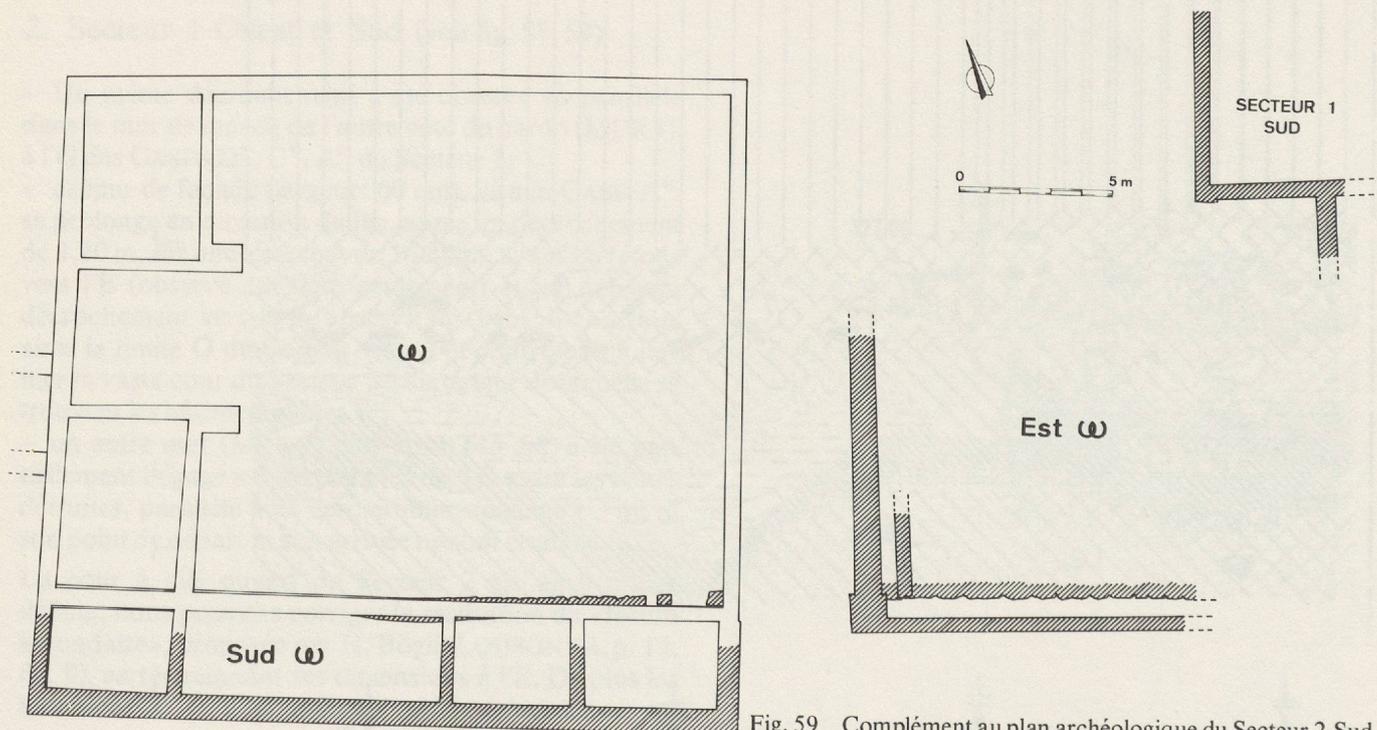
Complément au plan archéologique du Secteur 2-Sud.
